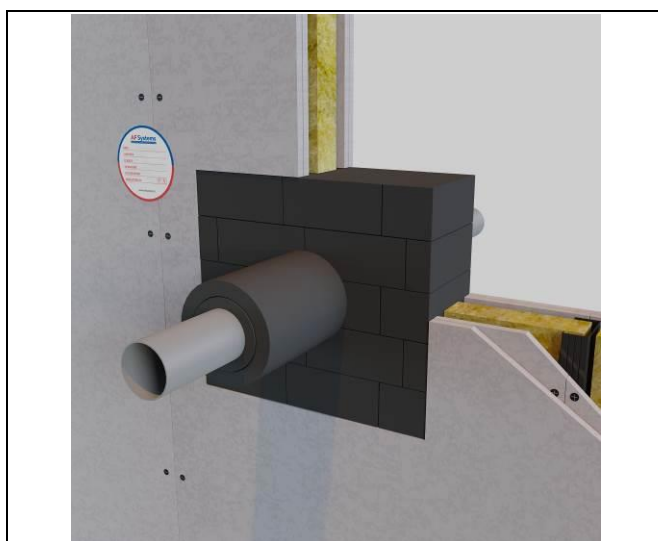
Esempio di sigillatura con AF BRICK di attraversamenti di tubazioni di acciaio con isolamento in pareti flessibili.
